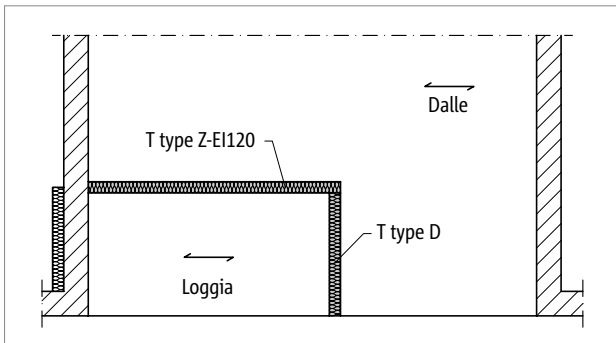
Schöck Rutherma® T types D et Z : dalle portée sur deux appuis
